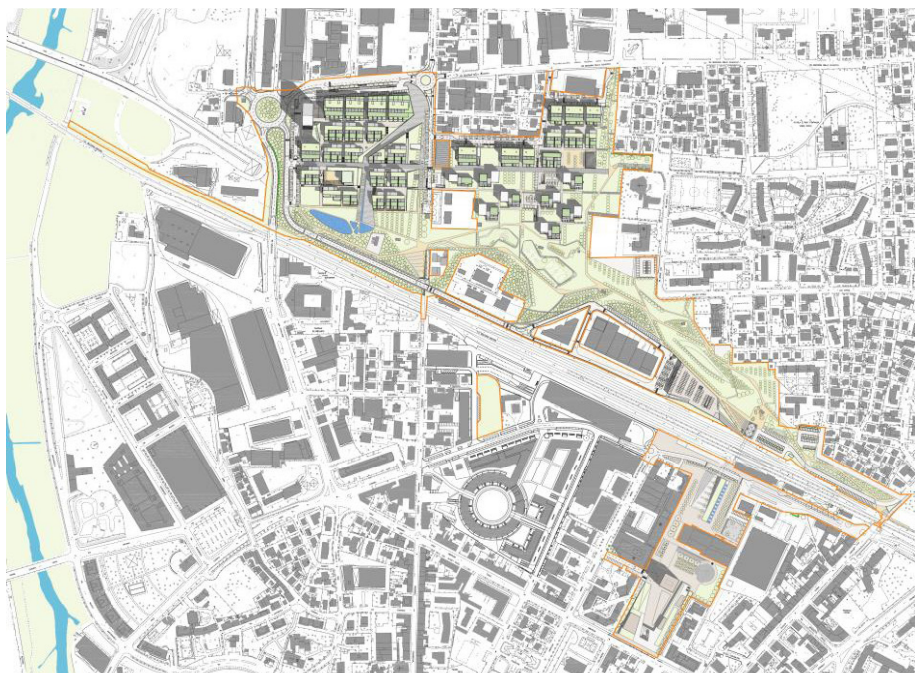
1 - Planivolumetrico del progetto (fonte: stralcio tav. 5.0, PRU)
